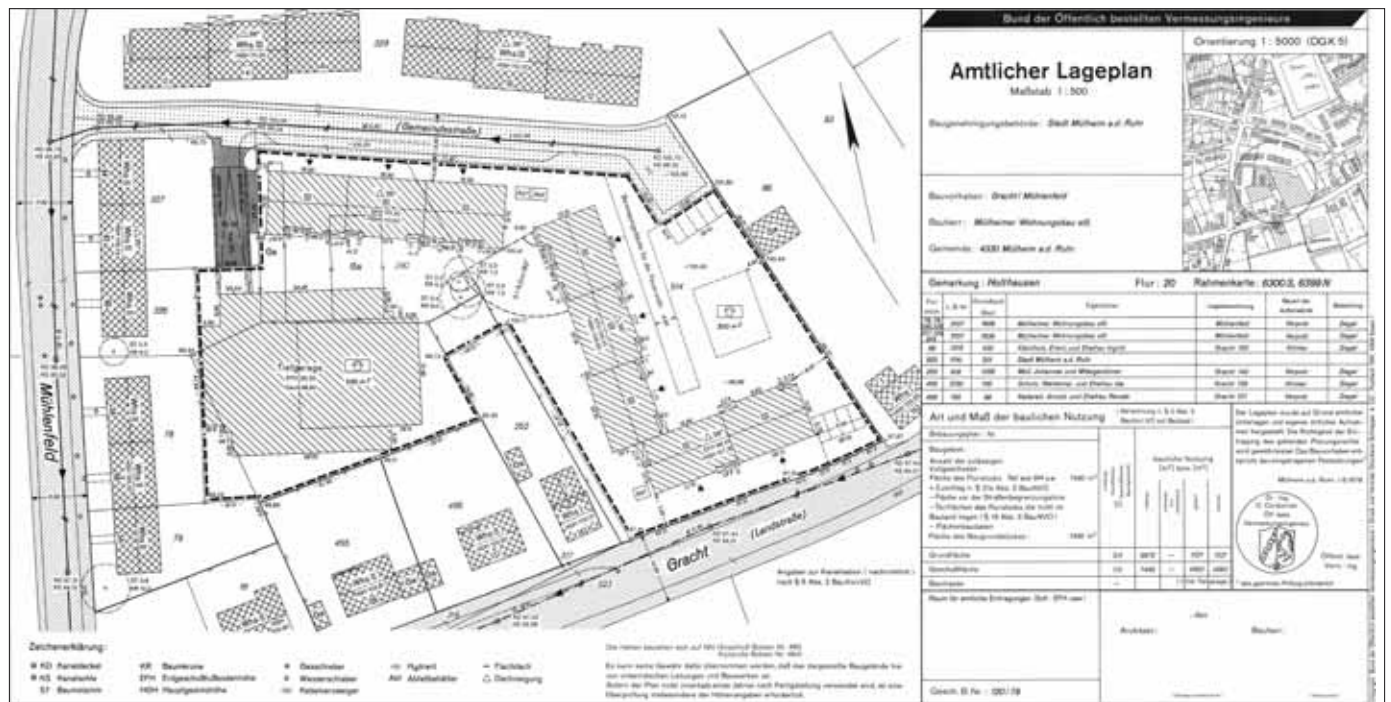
| Musterlageplan BDVI Nordrhein-Westfalen 1979, Beilage zu FORUM 3/1979
